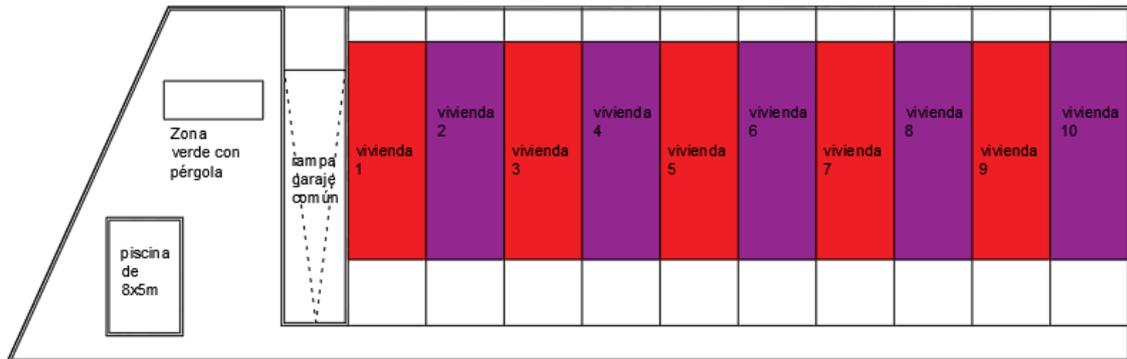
Plano de distribución de planta baja. Fuente: elaboración propia
